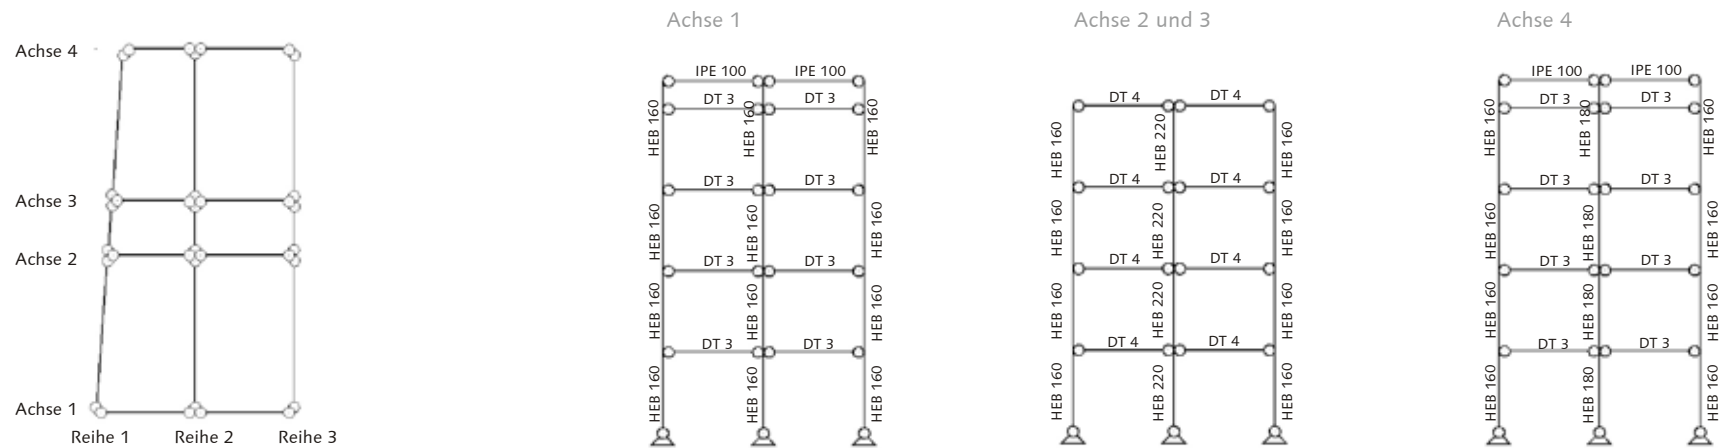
Grundriss Gelenk II - Haus 2
